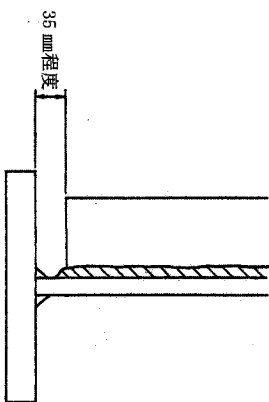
垂直補剛材と下フランジとの取合いの例
